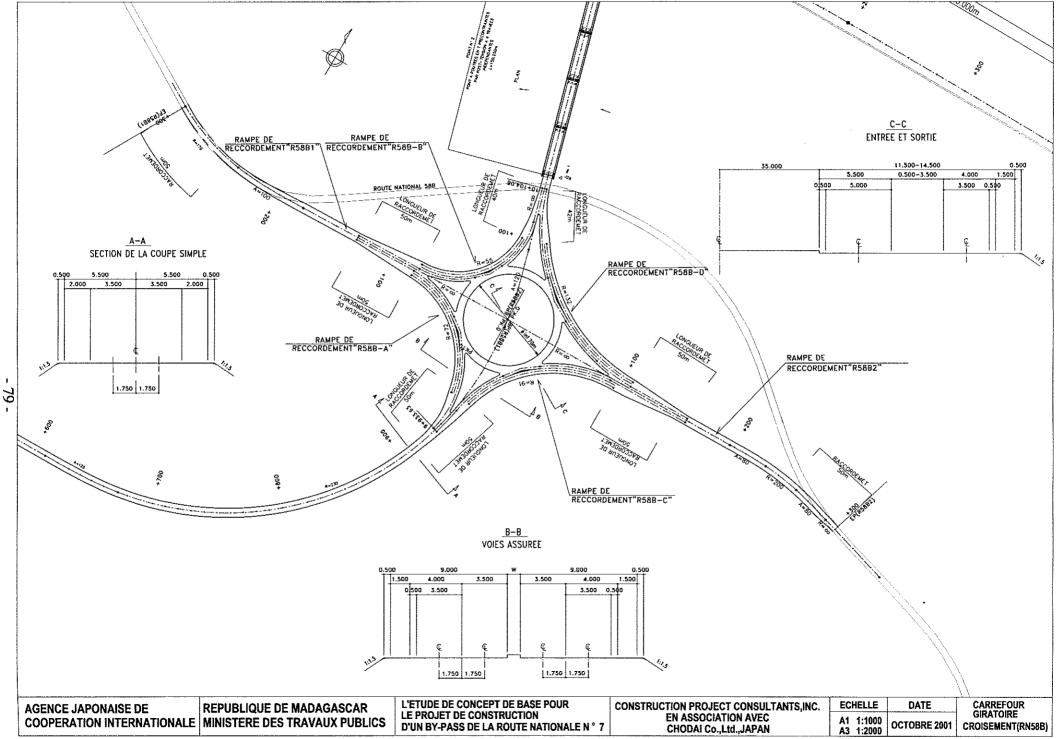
Carrefour Giratoire Croisement (2/3)
